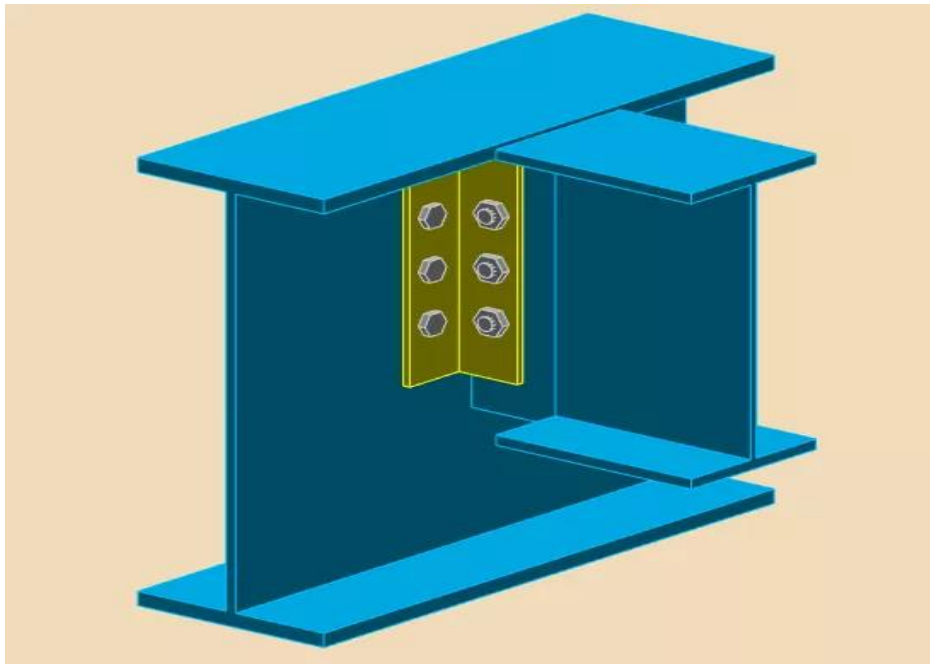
d'assemblage poutre-solive (IPE500-IPE330).
